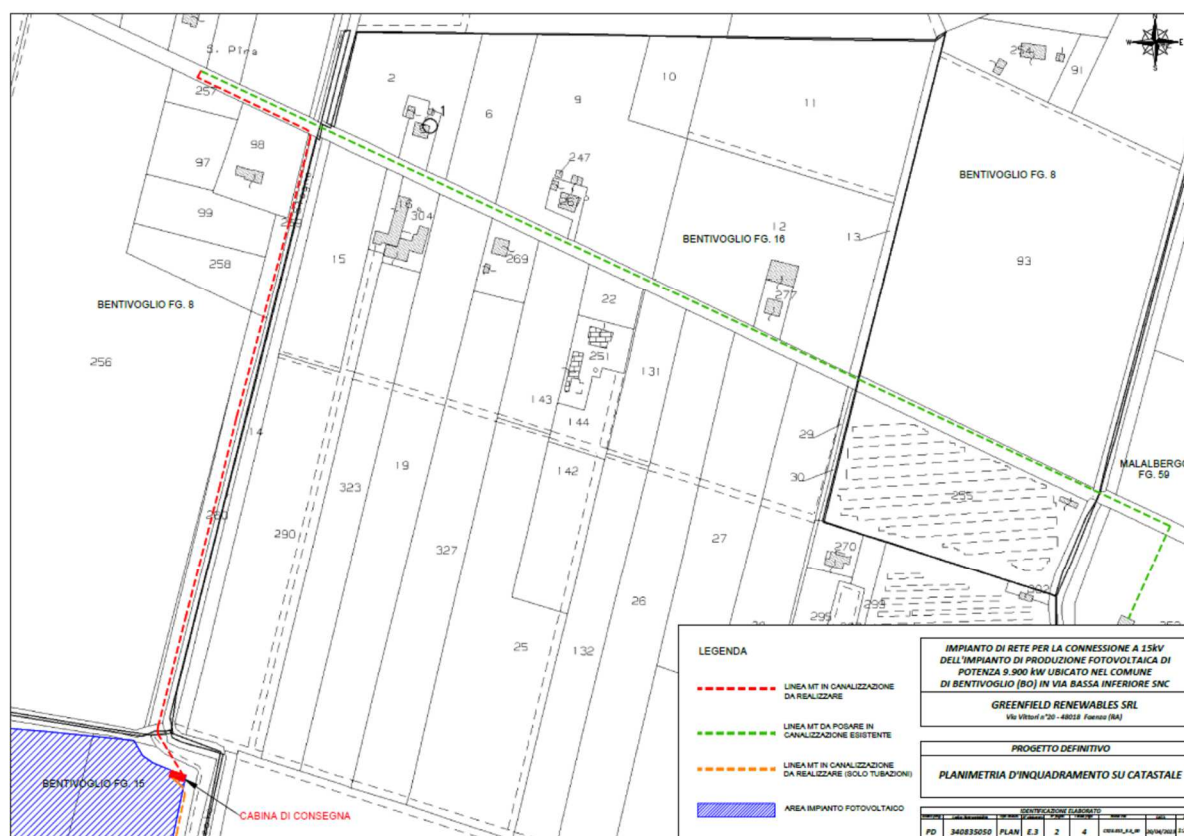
Planimetria elettrodotto di connessione MT su base catastale.
